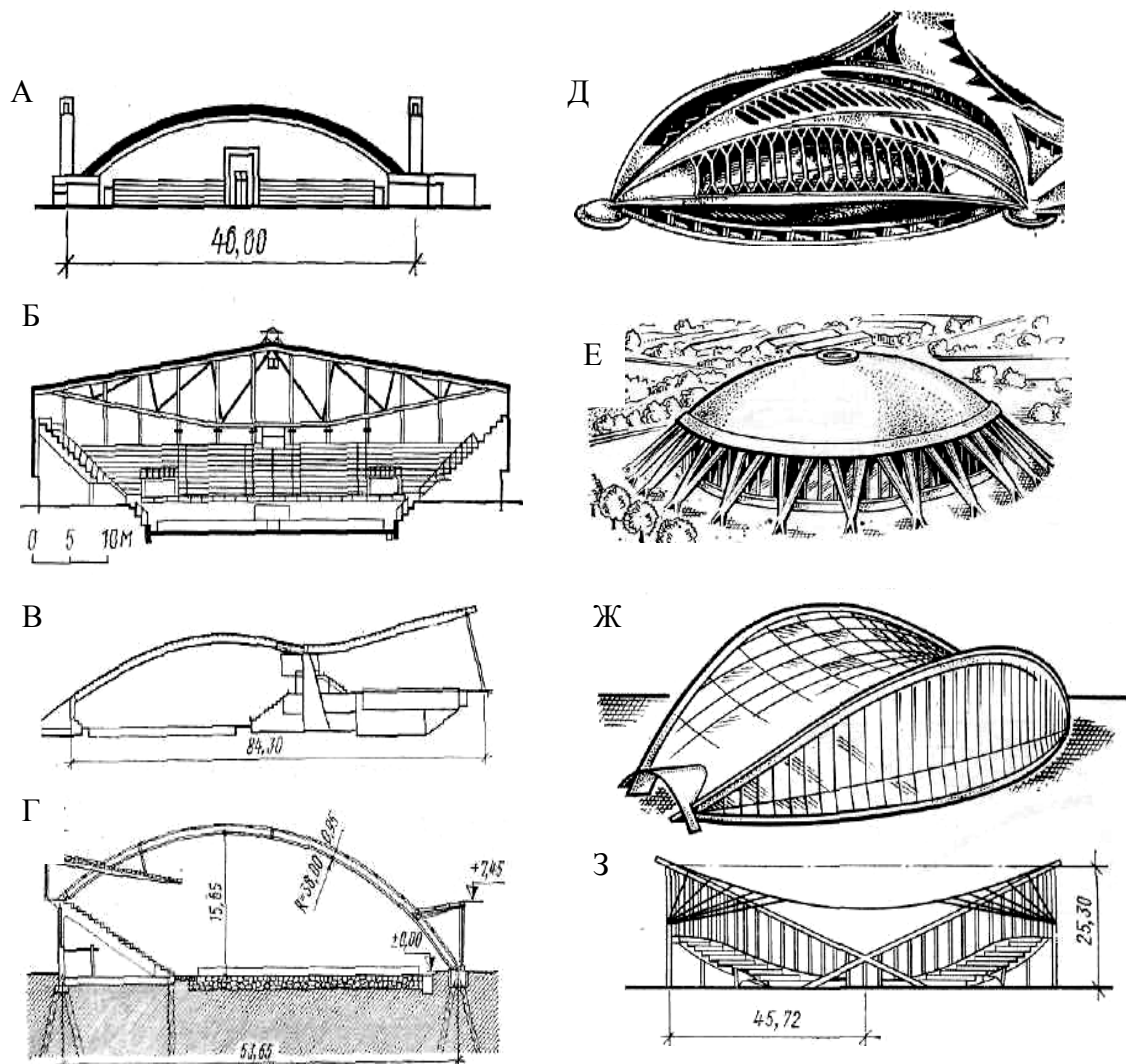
Примеры конструктивных и архитектурных решений крытых спортивных комплексов. А – спортивный зал в Амерсфорде (Нидерланды) – деревянные арки, Б – зал с хоккейной ареной в г. Оуду (Финляндия) – деревоклеянные конструкции, растяжка ферм из круглой стали, В – спортивный комплекс с хоккейной ареной и бассейном в г. Реймсе – деревоклеянная балка, Г – крытый каток в Гренобле (Франция) – деревоклеянные конструкции, Д – спортивно-зрелищный зал в г. Нордфолде (США) – сборно-монолитный сферический купол, Е – крытый велодром Олимпийского комплекса в Монреале (Канада) – железобетонные конструкции, Ж – крытый стадион с хоккейной ареной в Париже – преднапряженная сетка стальных тросов, З – релей-арена в США – перекрестная сетка тросов.
